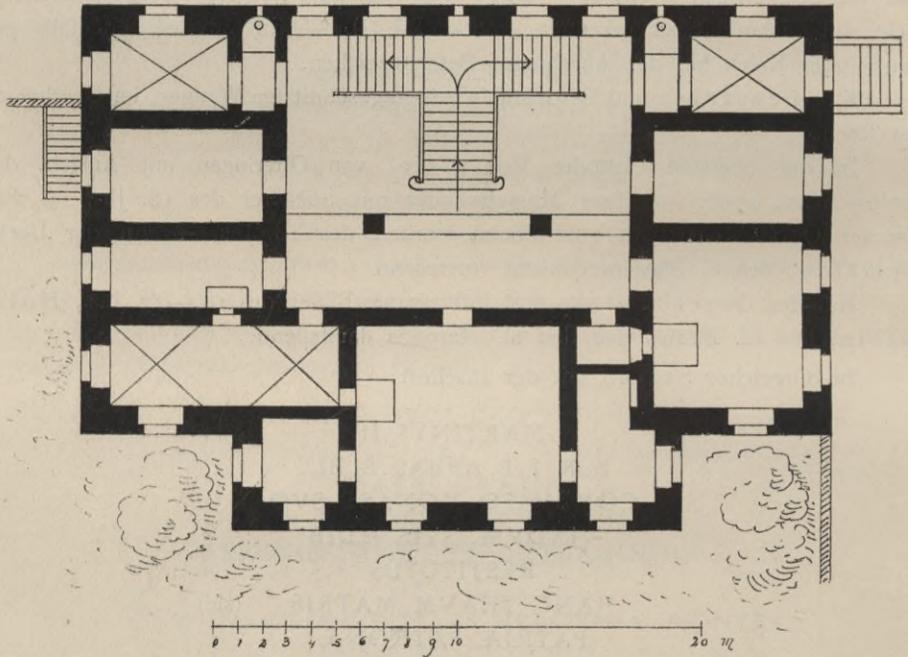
Todtmoos. Ehemaliger Palast, jetzt Pfarrhaus. Grundriss.
